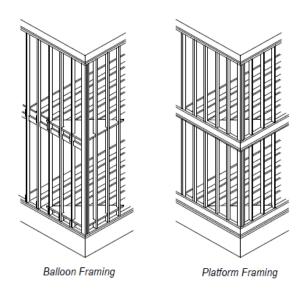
Esquema de construcción "*Ballon*" y "*Platform*" Framing. Fuente: (ConsulSteel, 2014).
